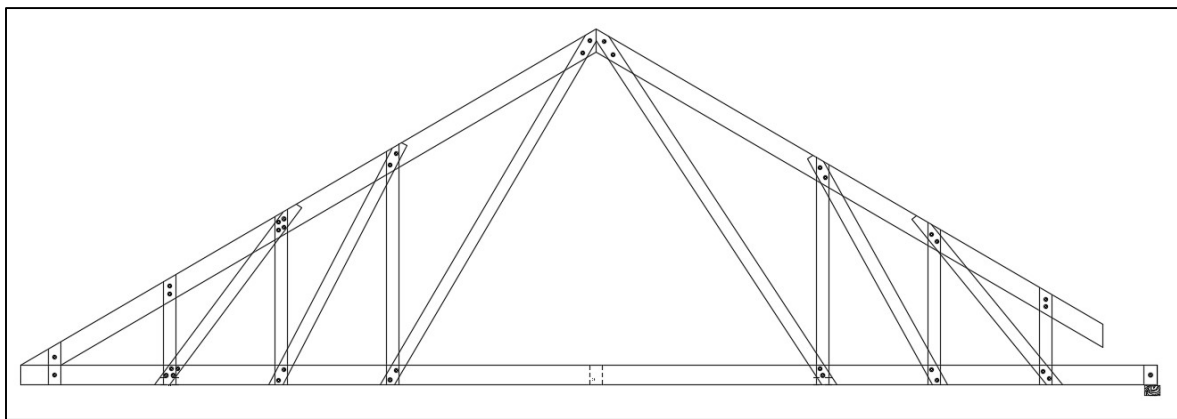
Armadura tipo de la estructura. (Fuente: Propia; 2019)
